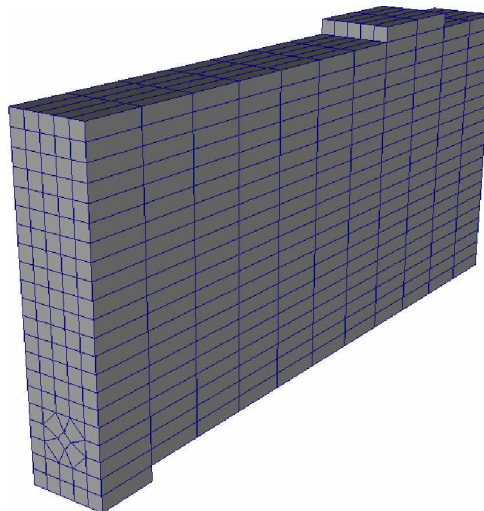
Maillage d'un quart d'une des poutres en béton armé testée par [25] – vue de l'extérieur.
